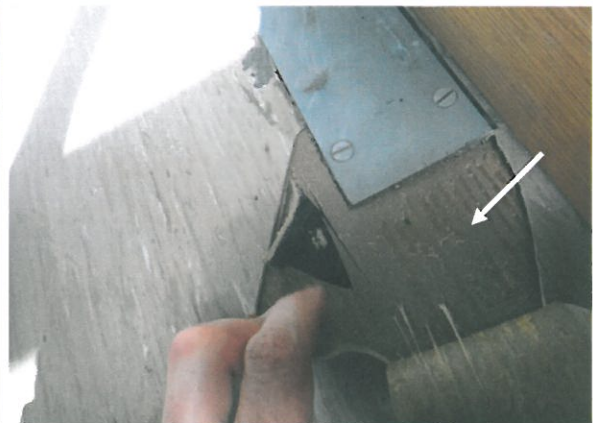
Turnhalle: EG, Halle, PVC-Bodenbelag
